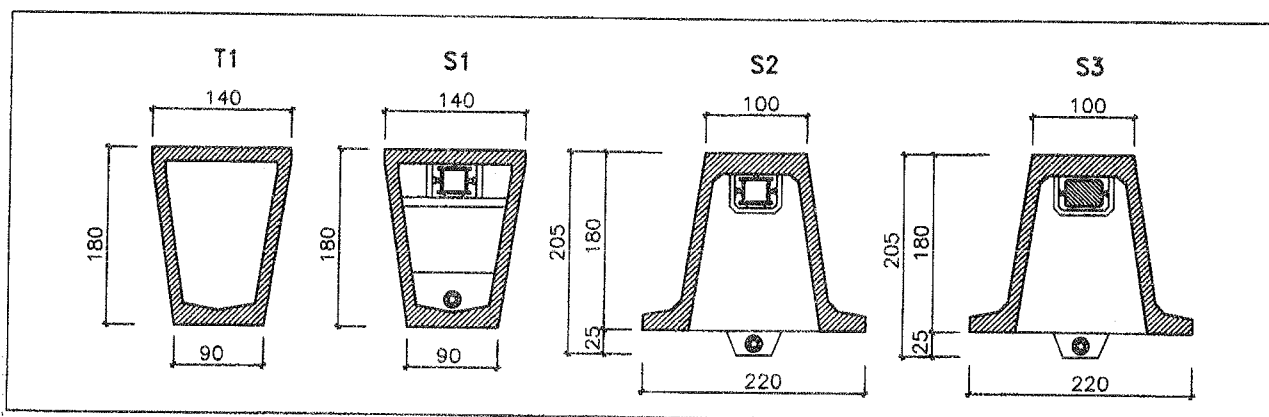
sezioni trasversali delle strutture T1, S1, S2, S3
